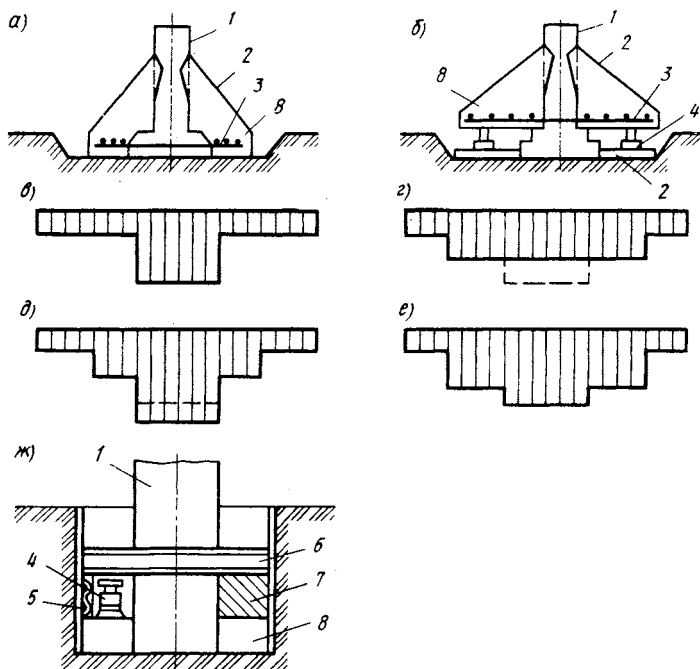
Конструкции уширения подошвы фундаментов:
